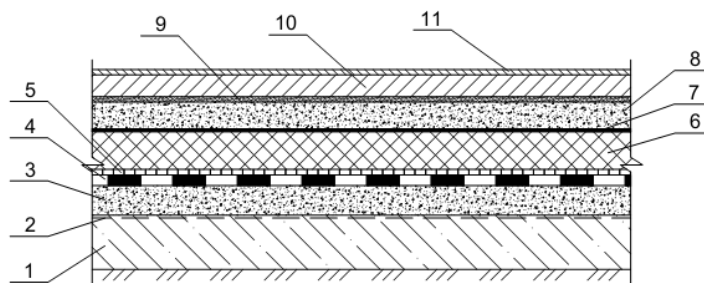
Схема утеплення підлоги на ґрунті в загальних приміщеннях будівлі
